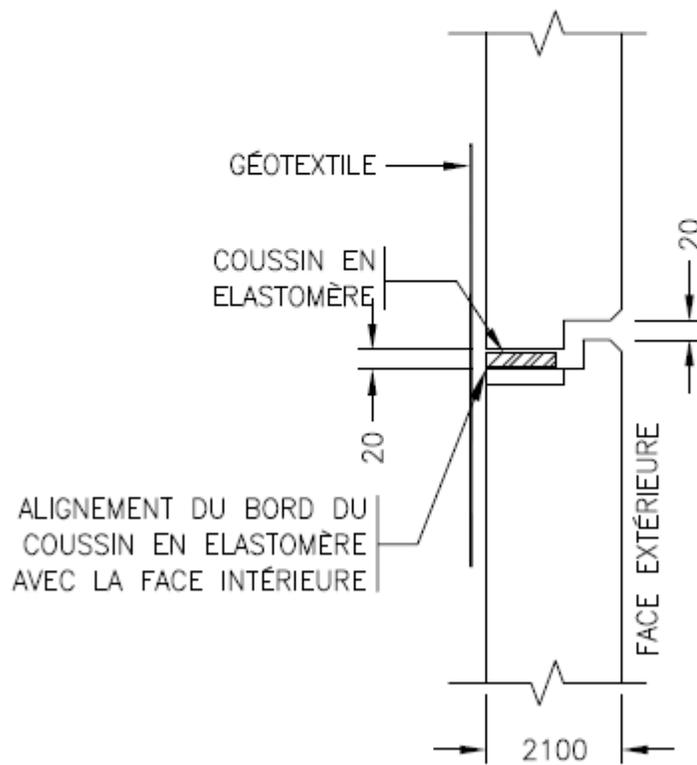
Joint horizontal et verticaux typique – Panneaux cruciforme
